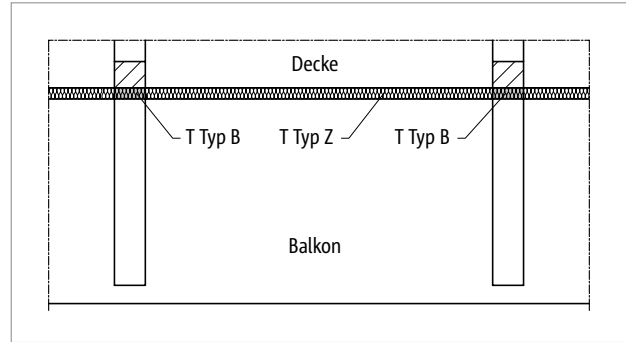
Schöck Isokorb® T Typ B: Balkonkonstruktion mit frei ausragenden Unterzügen
